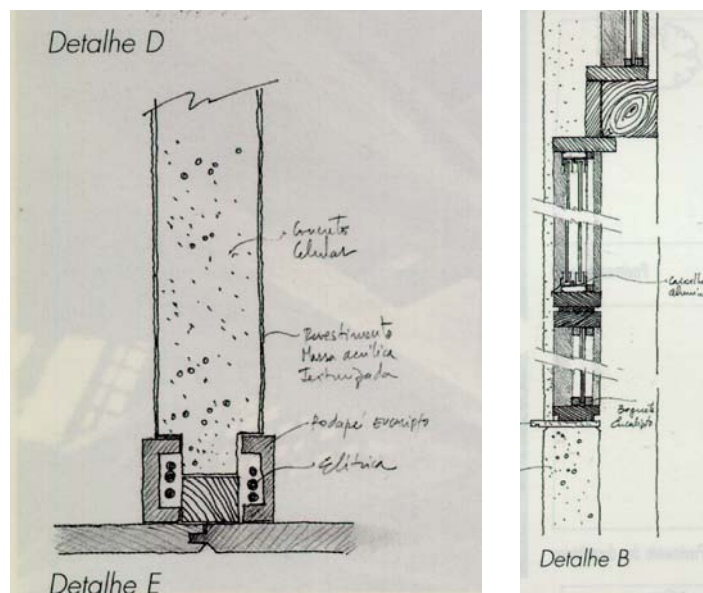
Detalhes construtivos. Fonte: SANTOS, 200?
